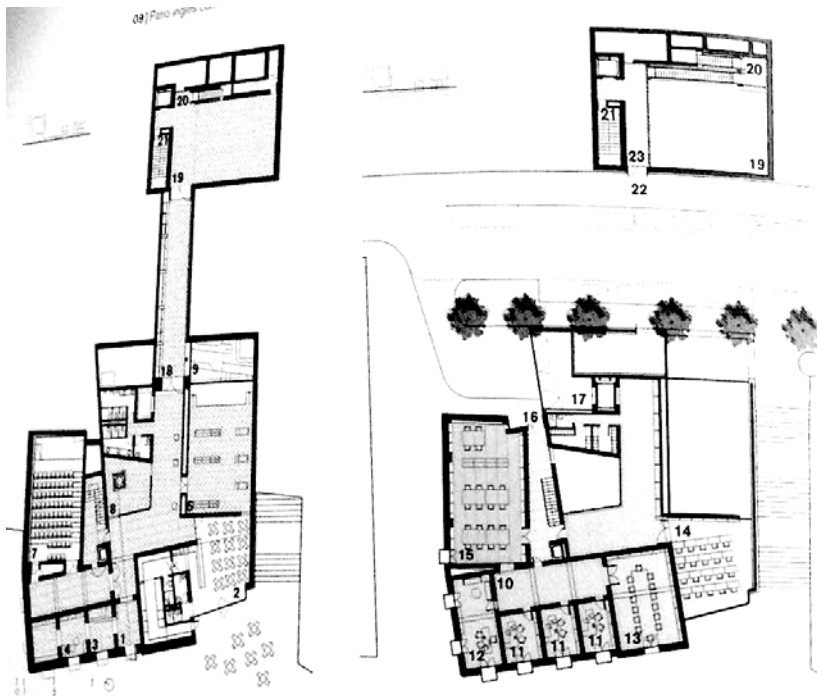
Planta baja y primera del edificio Casa-Palacio Pascual Riquelme. (Ramallo, 2009)
